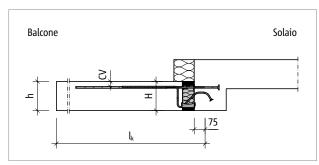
Schöck Isokorb® T tipo KP-M13 – M14: sistema statico
